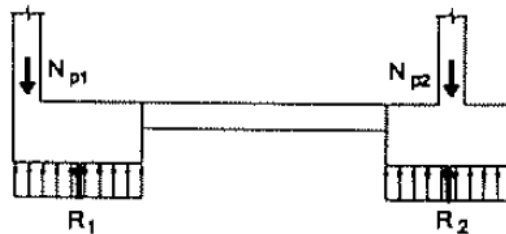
Zapata excéntrica con viga centradora. Calavera [15].
